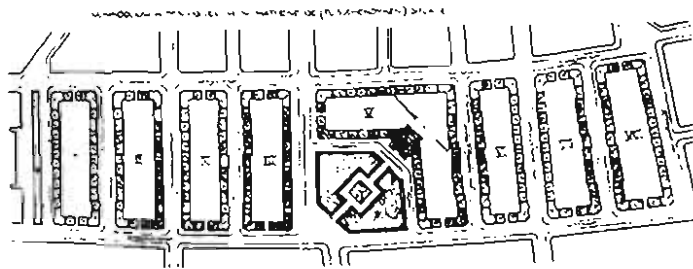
Rotterdam-Tusschendyken, Lageplan der von J.J.P. Oud geplanten Blöcke (1921-23)
